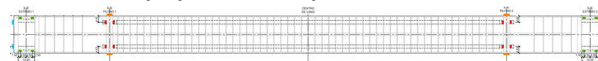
Planta del tablero con la disposición de topes dispuestos. Fuente: TYPESA.
